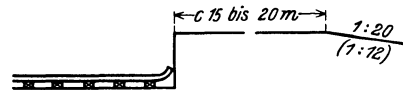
Längenschnitt einer Stirn- oder Kopframpe.
